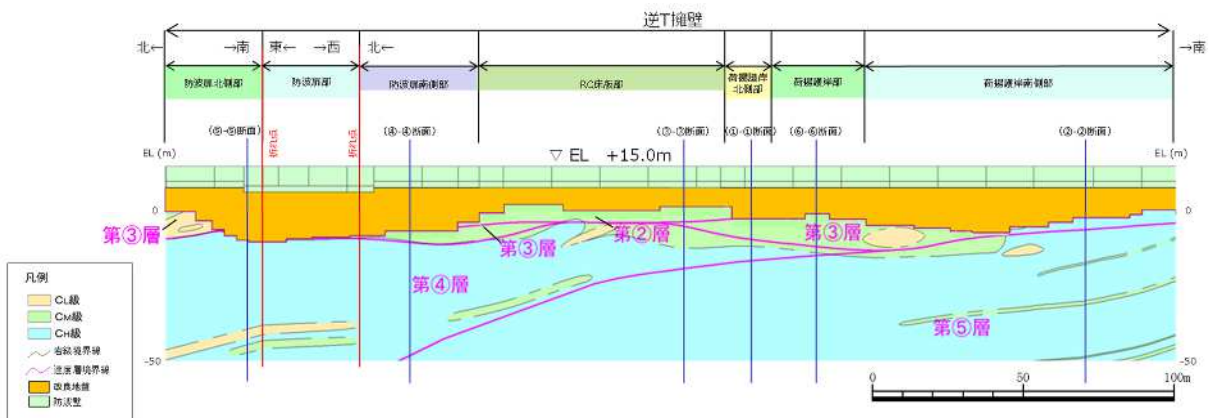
防波壁（逆 T 擁壁）縦断面図
